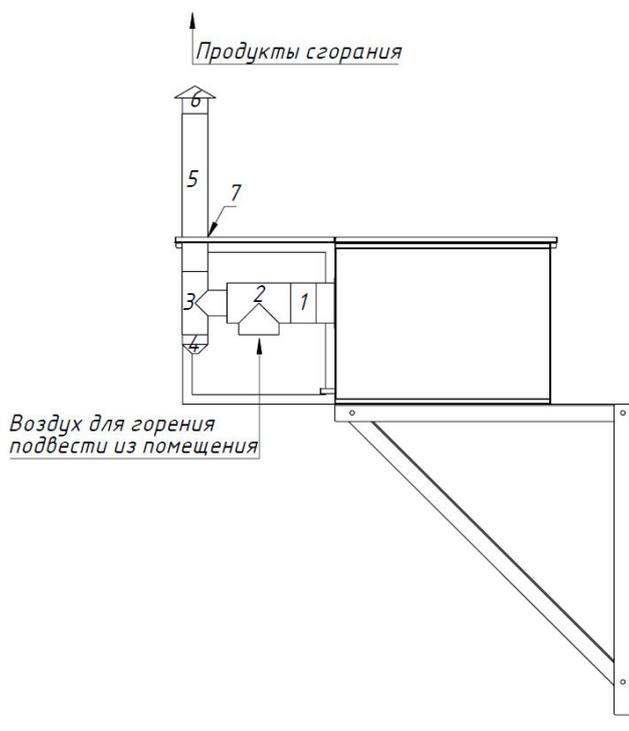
Горизонтальный коаксиальный дымоход SA1 0040/0050/0065/0085 DT
